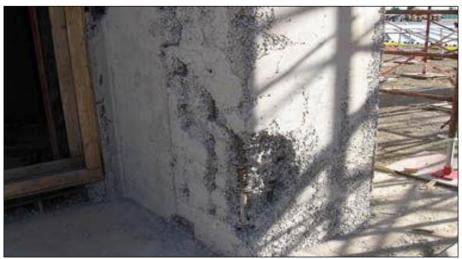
Vista de las Cangrejeras producidos por un mal colocado del concreto.
